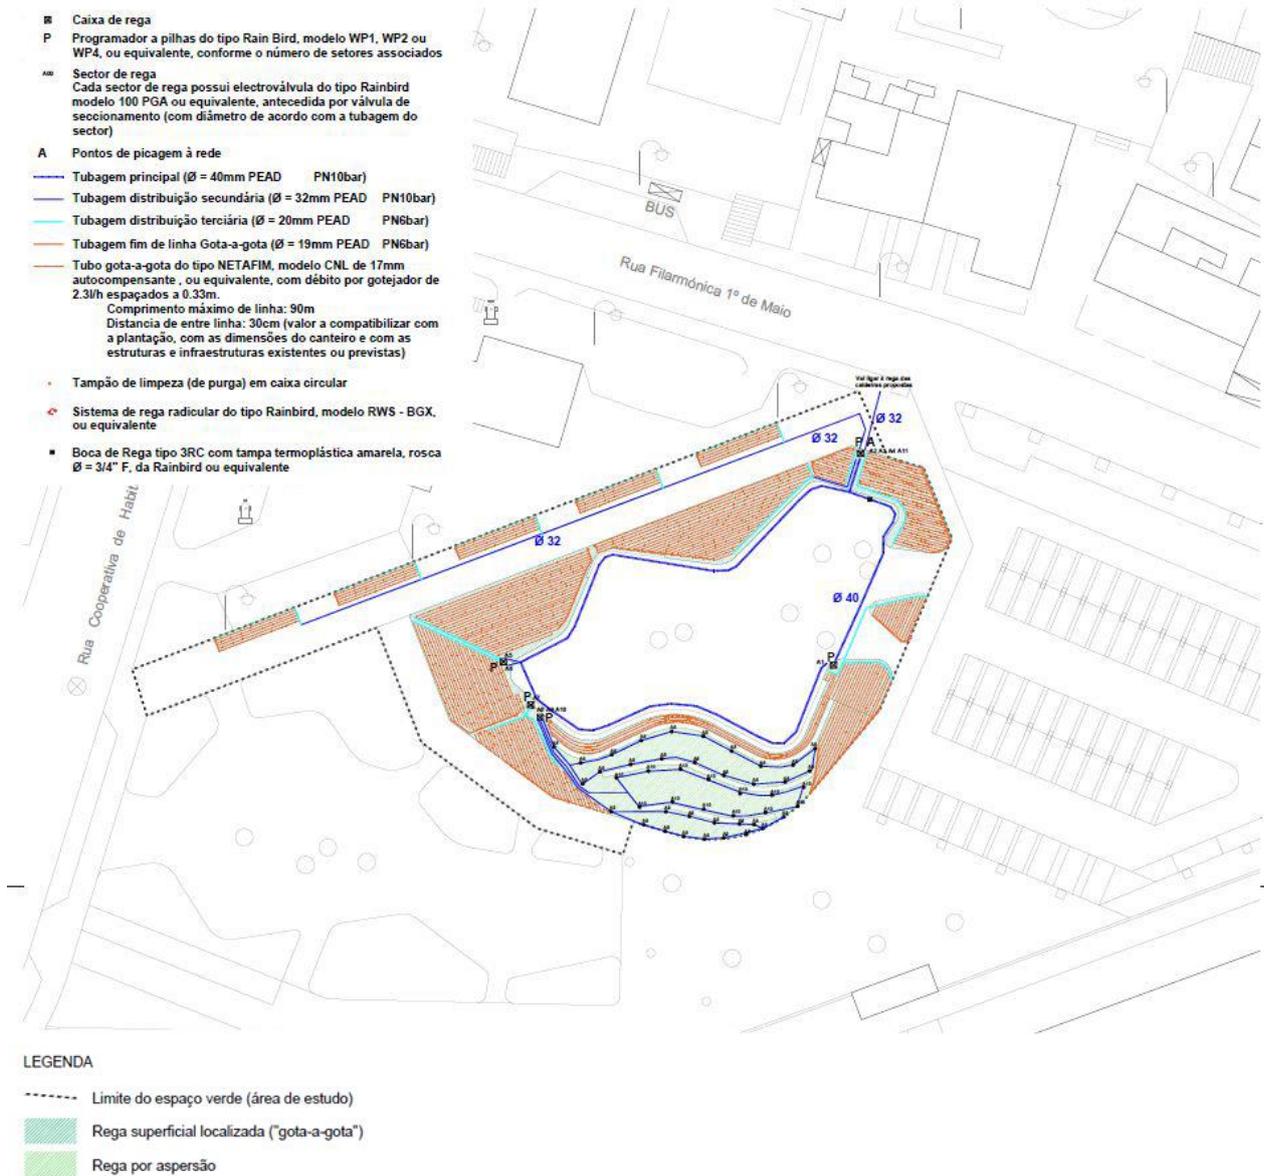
Exemplo de Planta de Gestão do Espaço Verde – Jardim do Coreto
